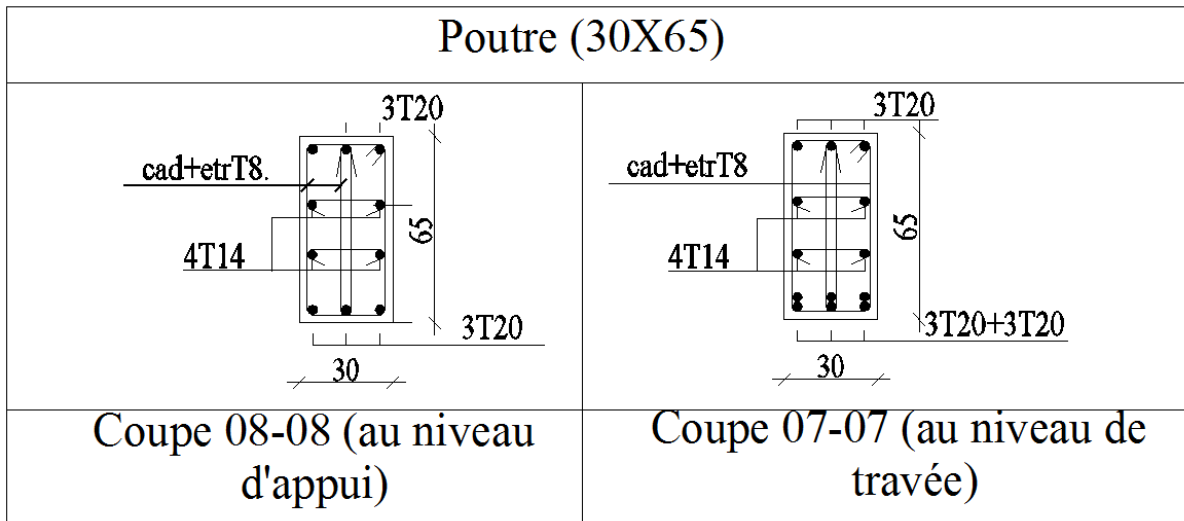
Schéma de ferrailage des poutres (30X65)
